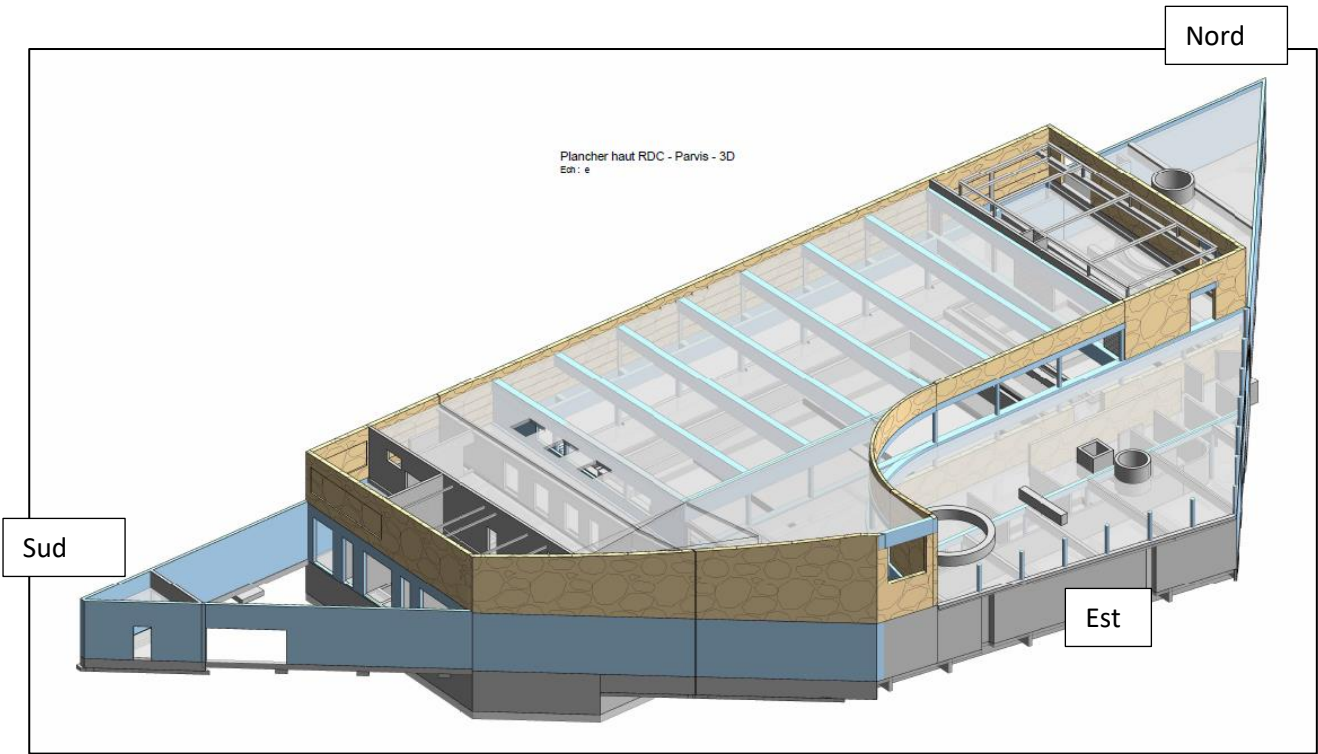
Extrait vue 3d plancher haut RDC PARVIS plan 2104 PRO
